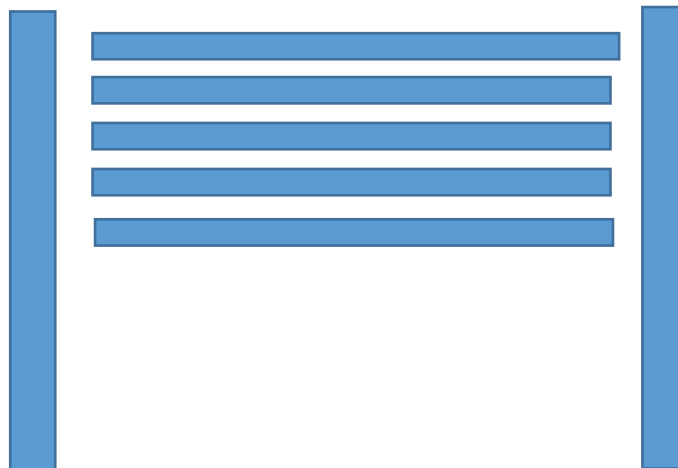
Vista esquemática em planta do assentamento do tipo paralelo.
